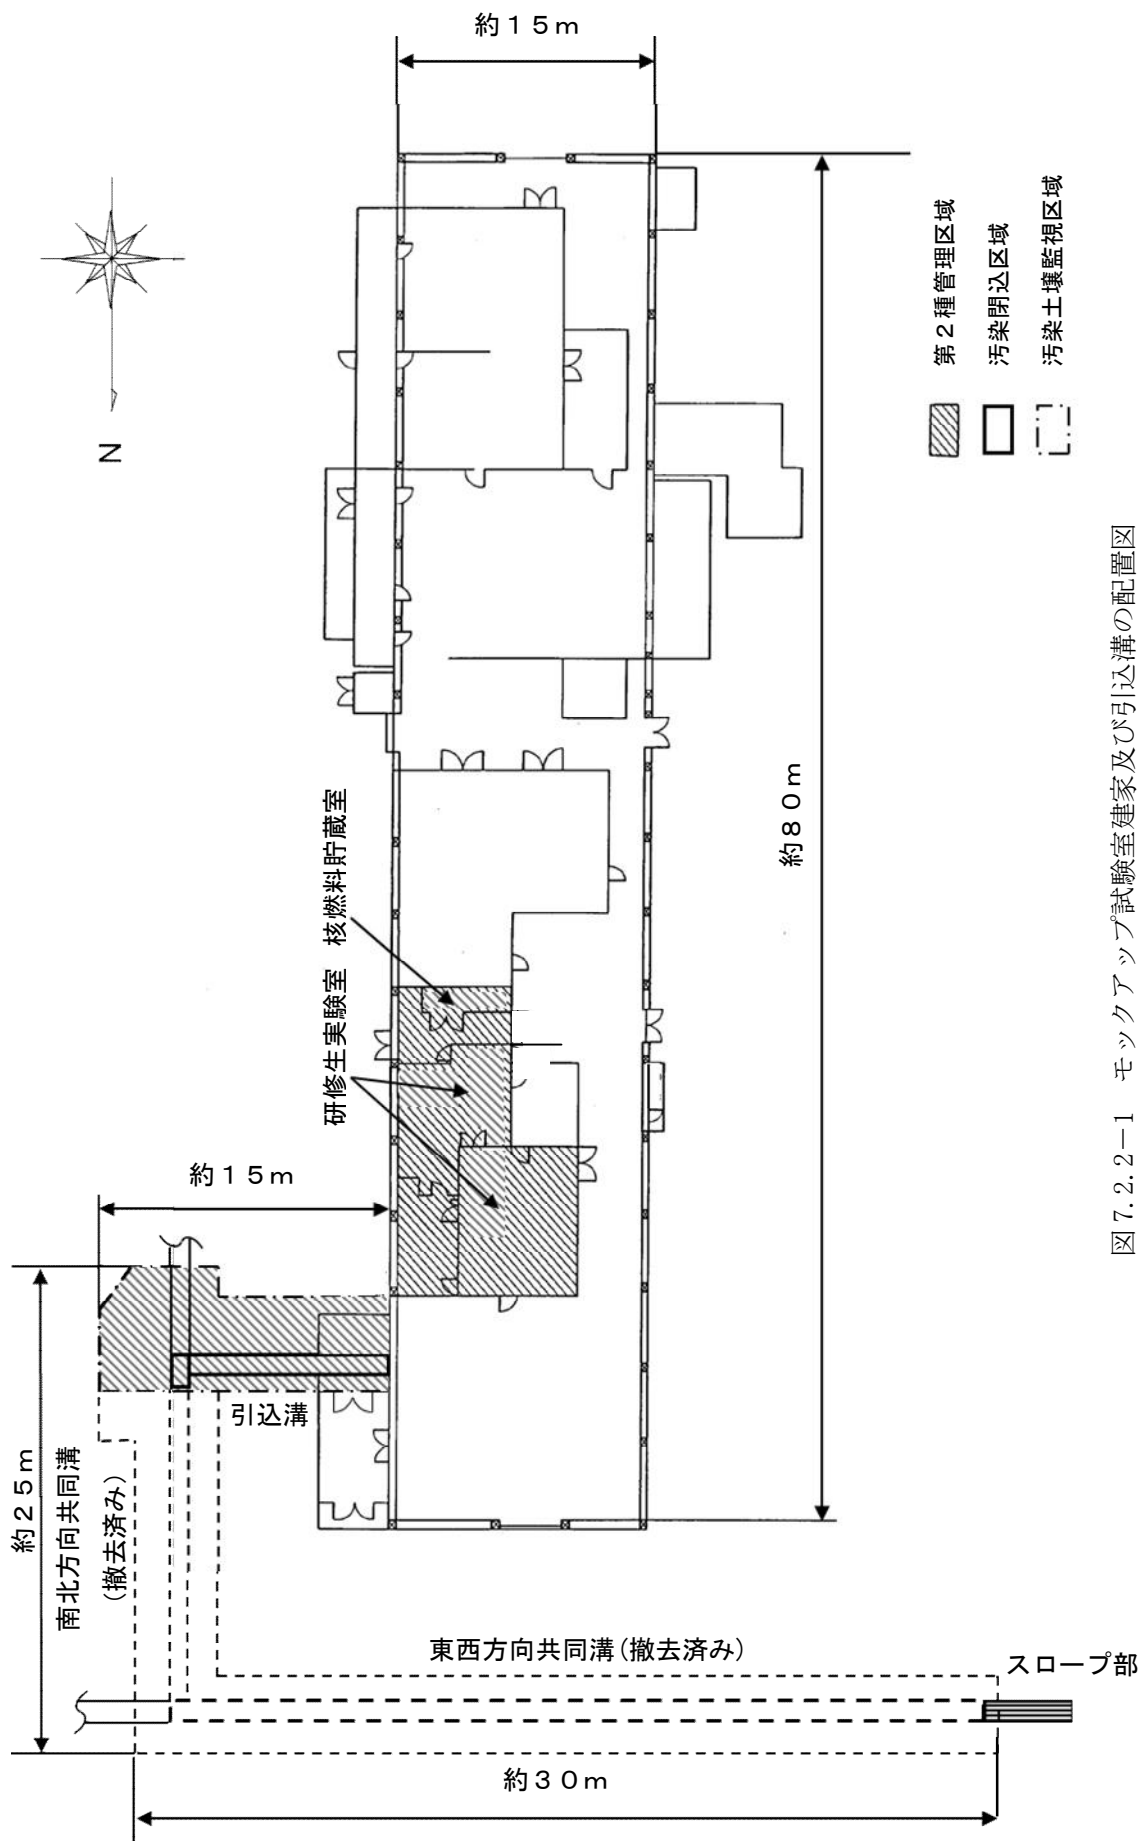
モックアップ試験室建家及び引込溝の配置図
